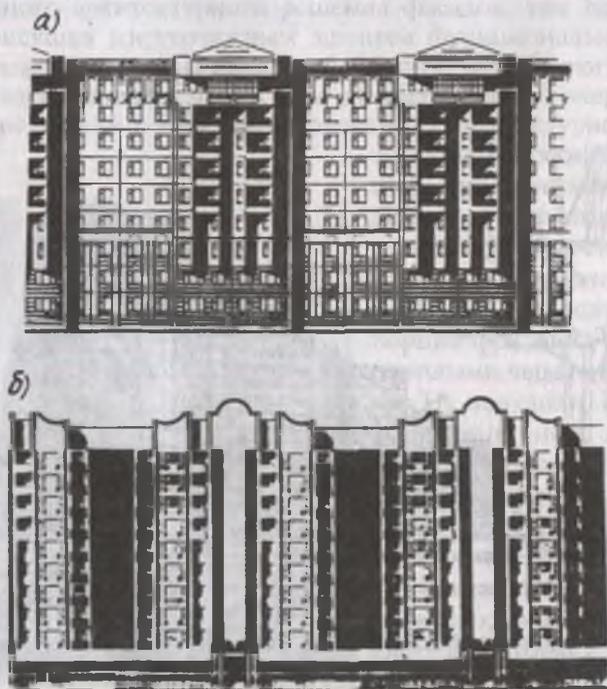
Композиции фасадов многоэтажных панельных домов с повторяющимися фасадными фрагментами:
